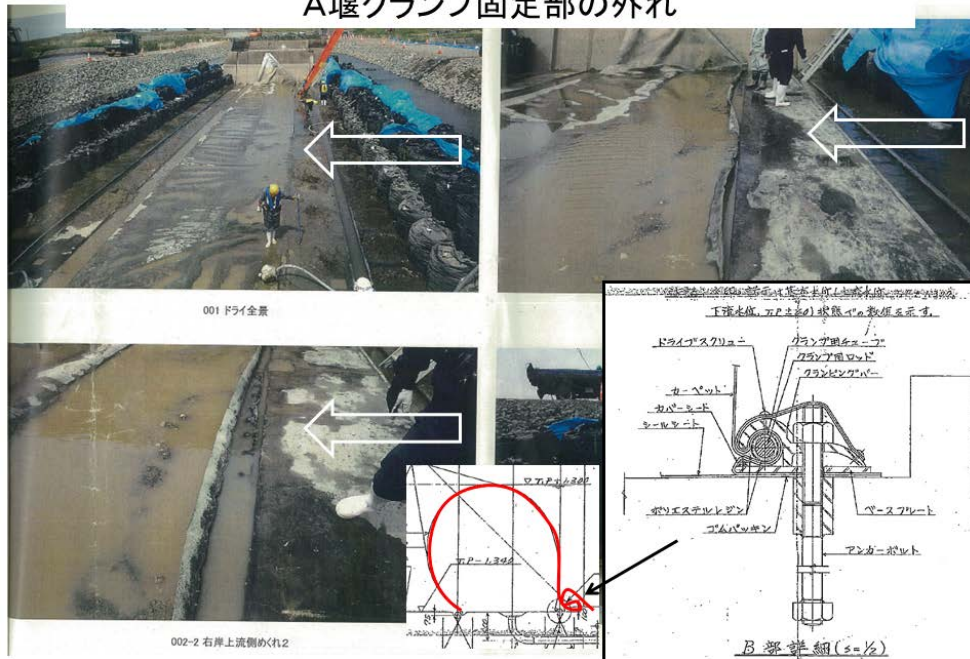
ゴム堰上流側固定クランプの外れ
